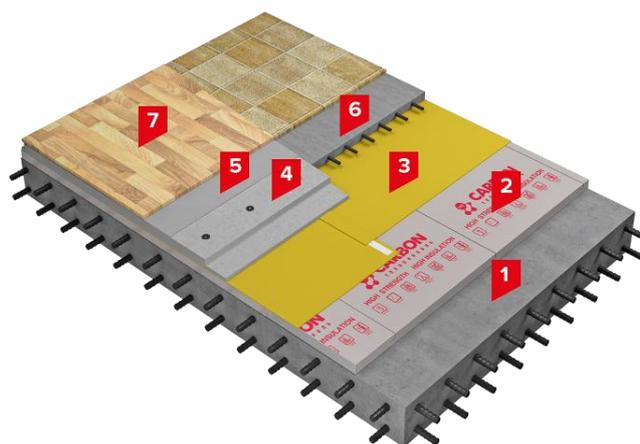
Конструктивное решение цокольного перекрытия над холодным подпольем:
